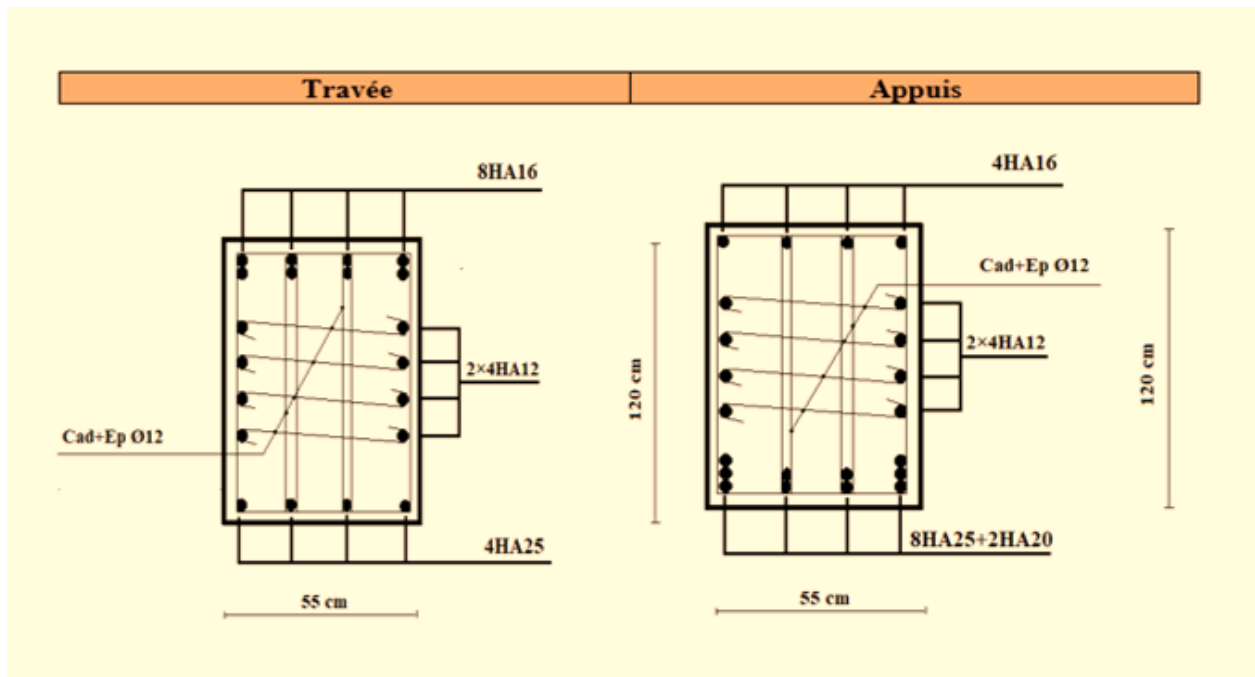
Coupe de ferrailage des nervures sens (X-X).
